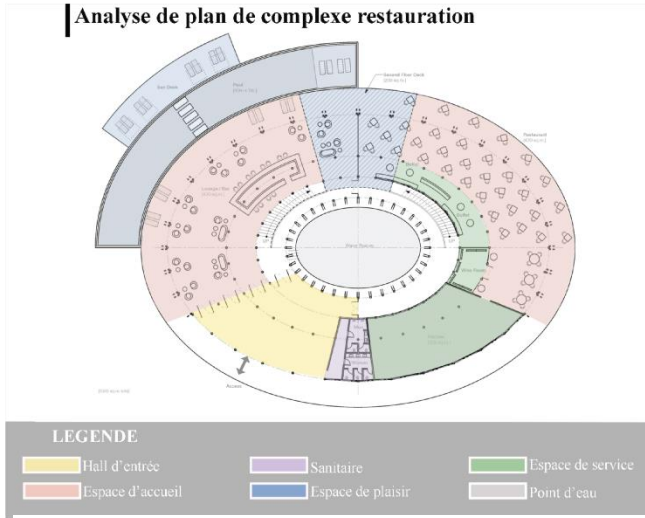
Plan d'équipement de Spa du restauration , source : Archdaily ,traitée par : Auteurs, 2025
